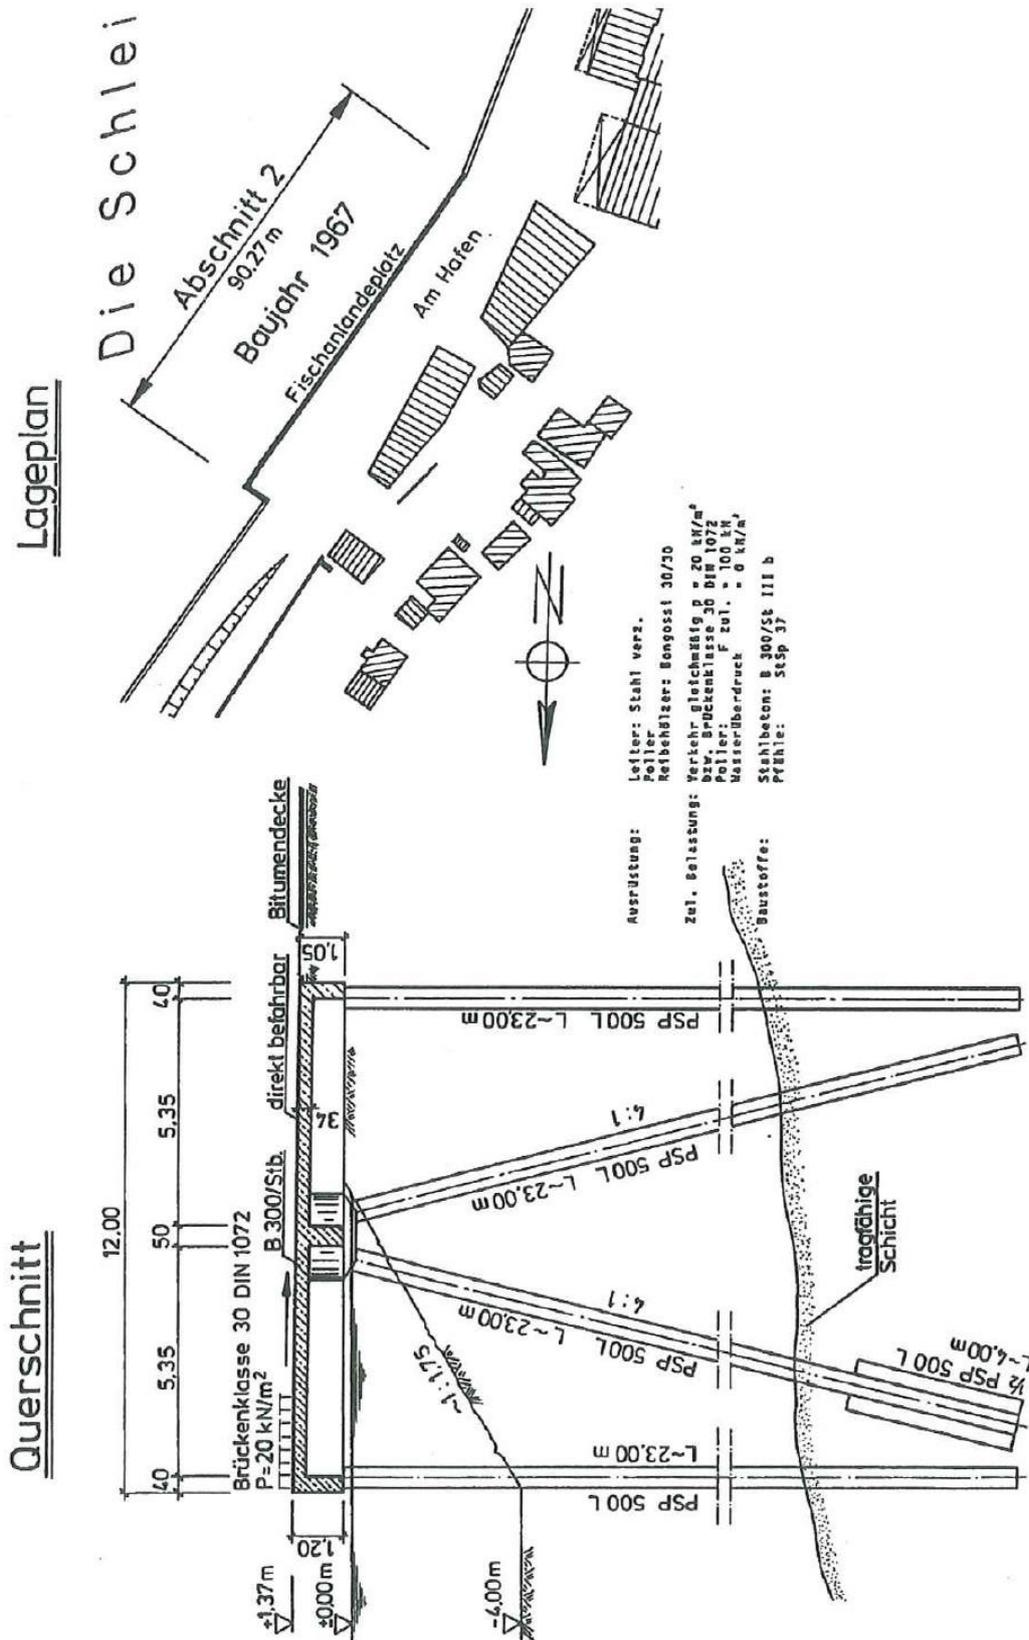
Querschnitt und Lageplan Fischanlandekai
